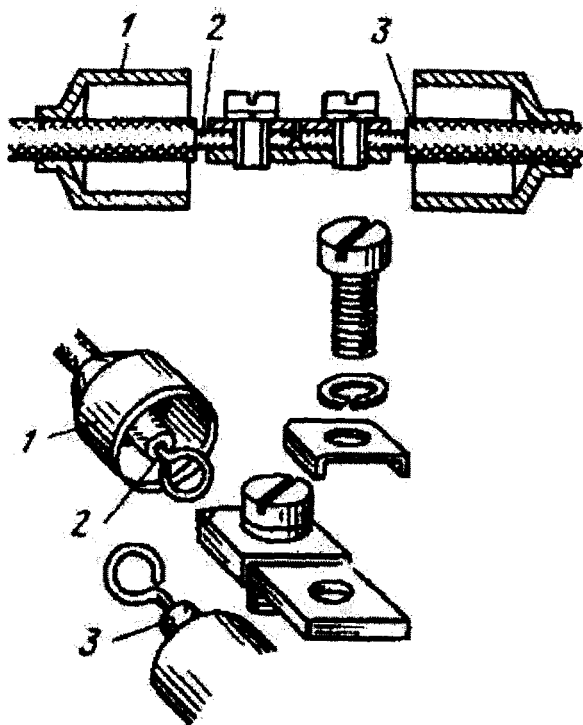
Соединение алюминиевых проводов сети с медными проводами осветительной арматуры:
